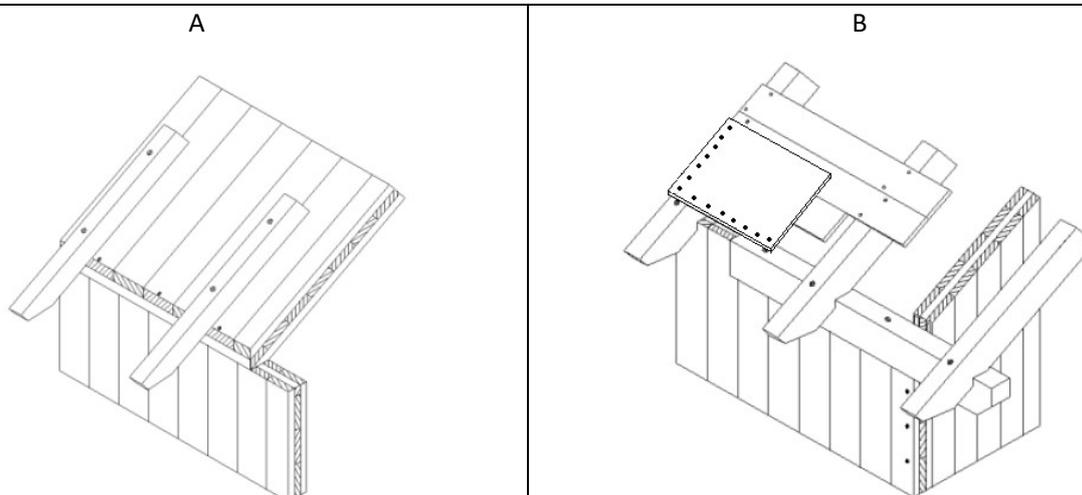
Soluzioni per il collegamento tra pareti e copertura. A Copertura in pannelli XLam con sporti di gronda realizzati mediante travetti passafuori B Copertura a travetti
